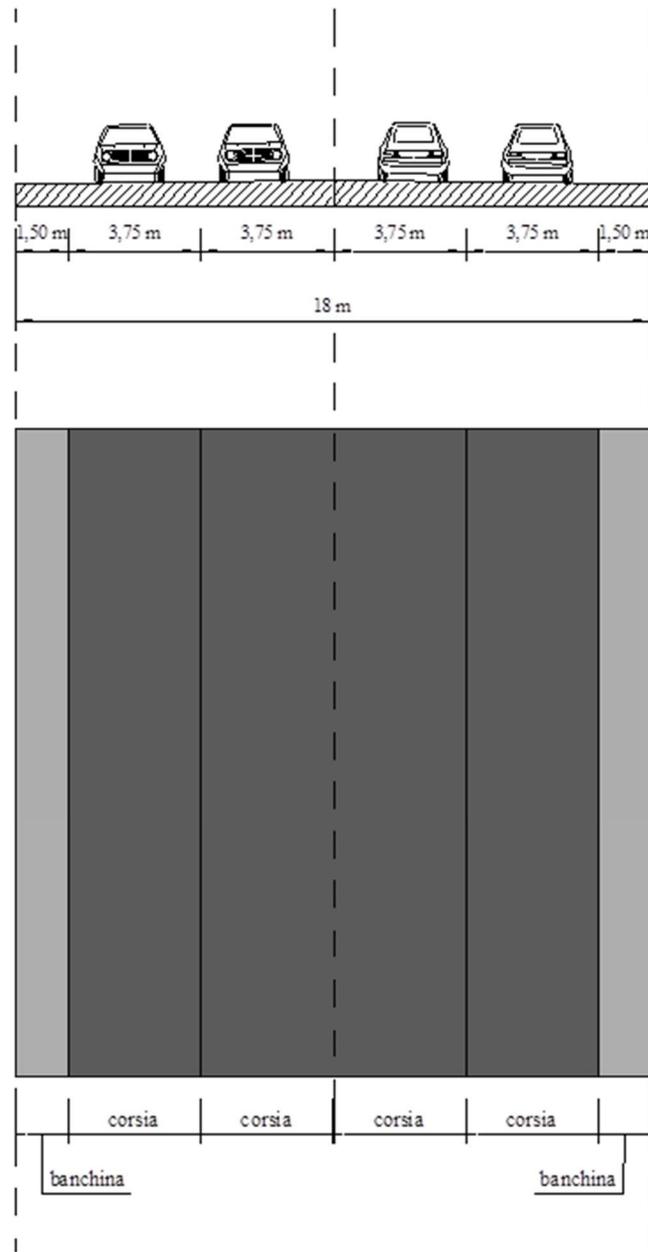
Sezione Tipo Strada Extraurbana Secondaria (C)
